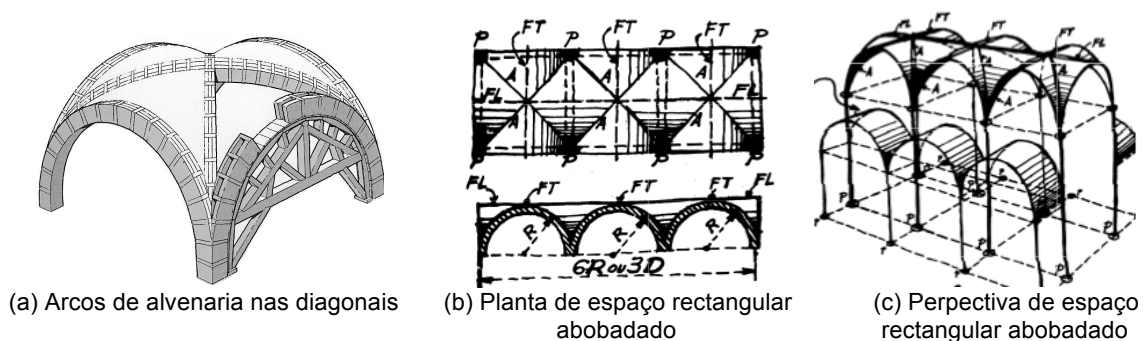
Pormenores de construção de abóbadas de aresta [7]
